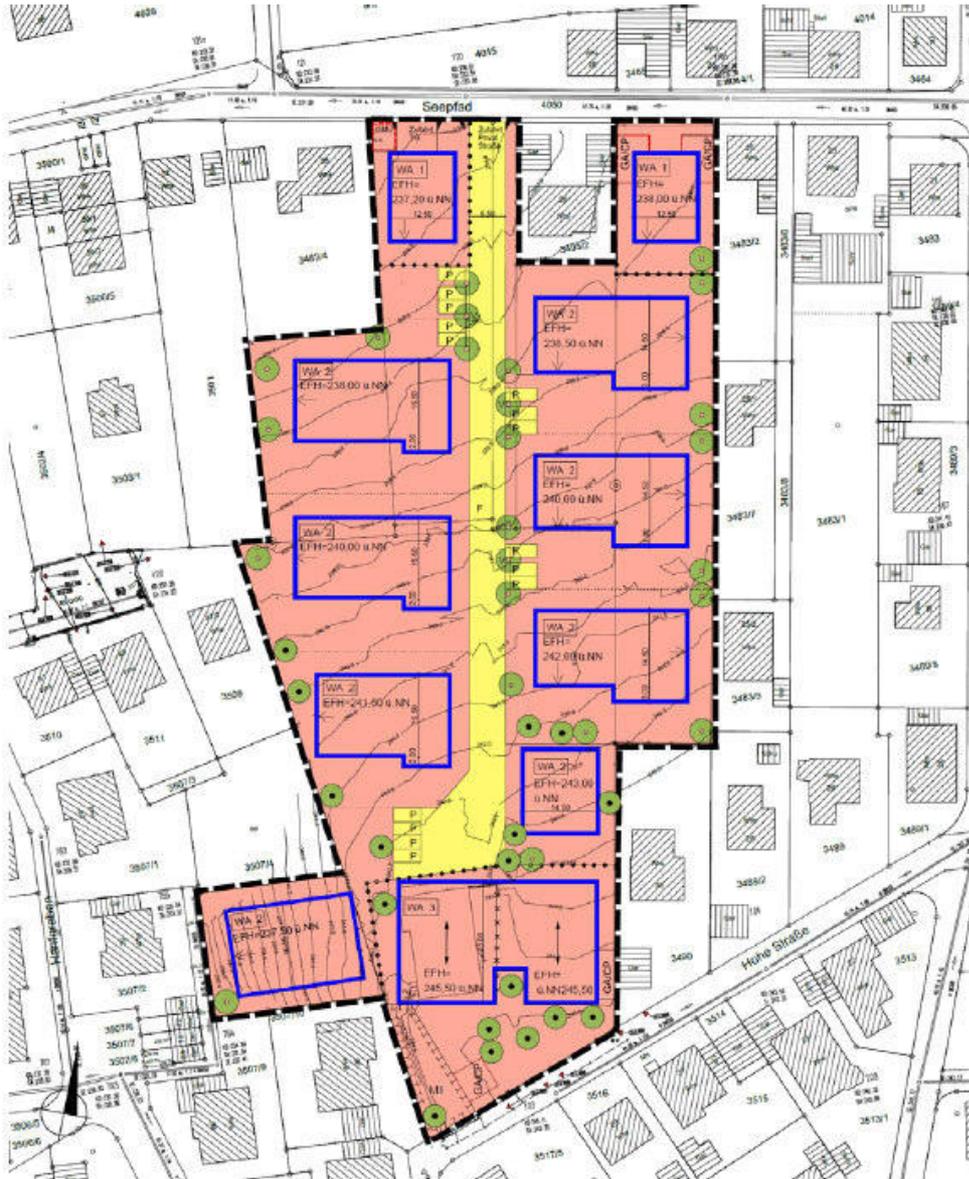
Entwurf zum Bebauungsplan. Verfasser: Architekturbüro Raff, Bietigheim-Bissingen.
